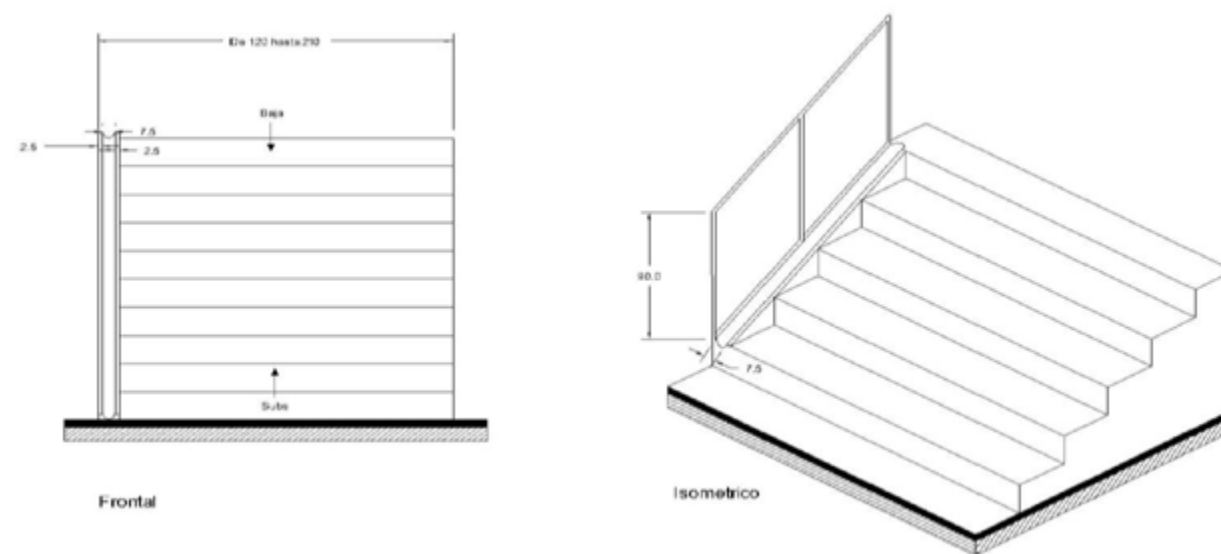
B. Rampa ciclista en escaleras con un ancho de 1.20 m a 2.10 m.
